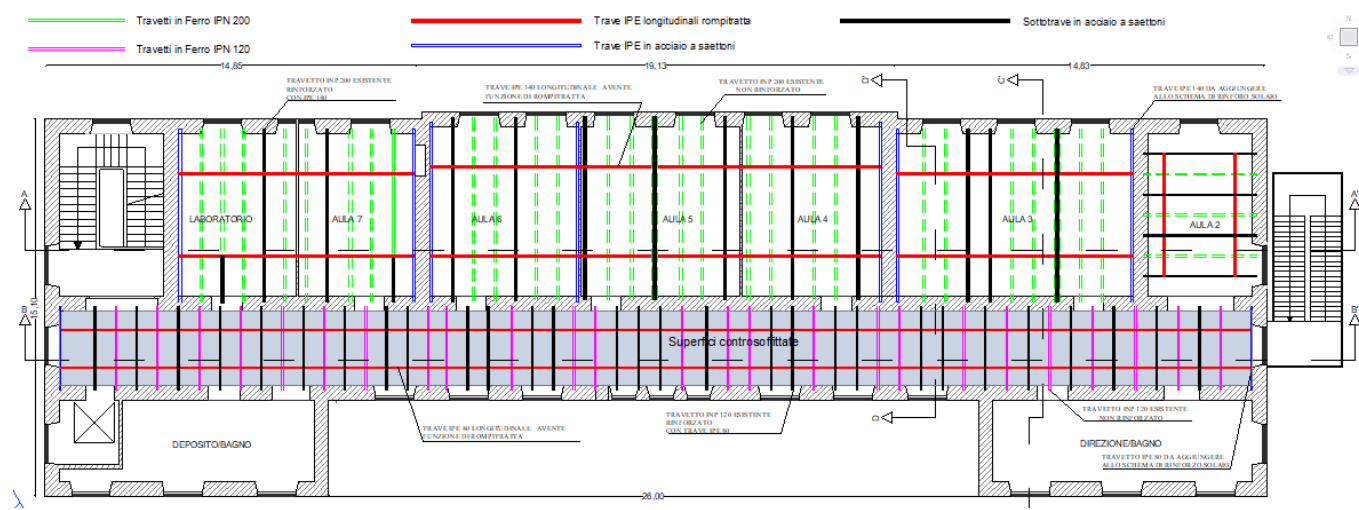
Planimetria piano tipo con schema di rinforzo dei solai
